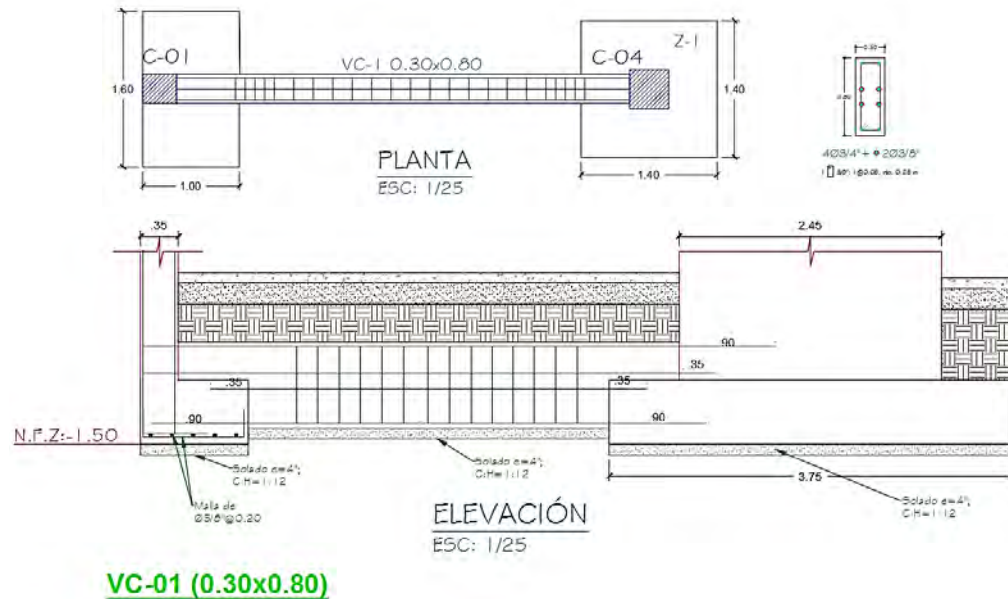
DISTRIBUCIÓN DE REFUERZO LONGITUDINAL Y TRANSVERSAL EN LA VIGA DE CIMENTACIÓN.
